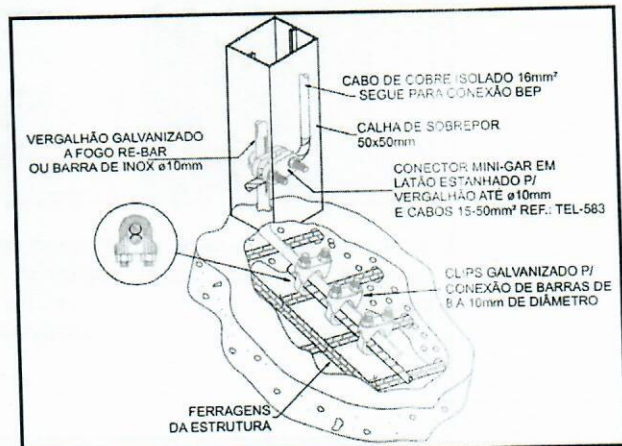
Amarração das ferragens do Radier com vergalhão galvanizado
